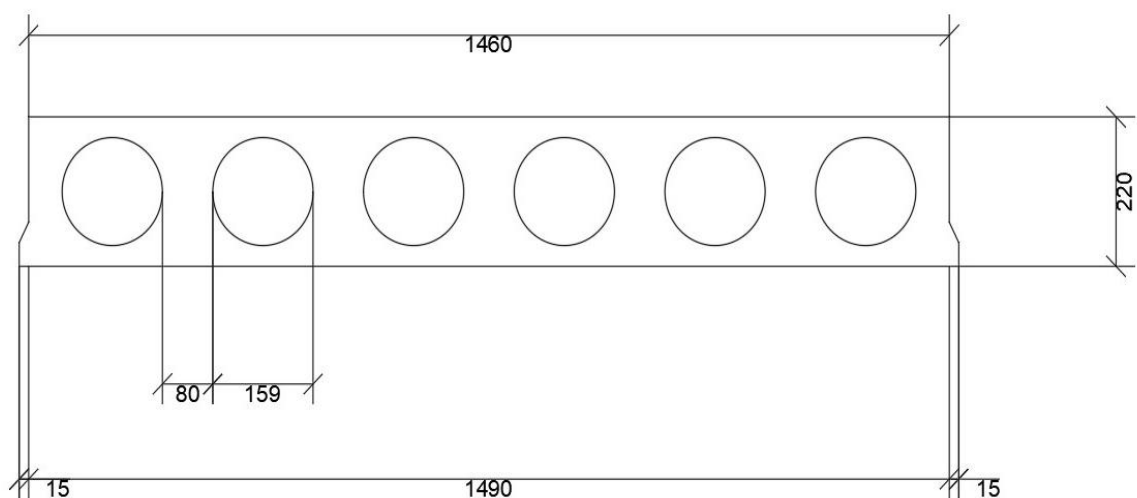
Поперечний переріз багатопустотної плити перекриття
